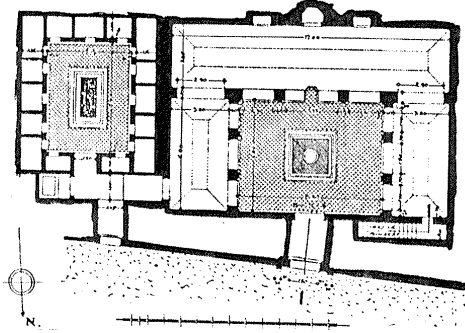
مسقط أفقي لمسجد الحمراء بفاس الجديد.
